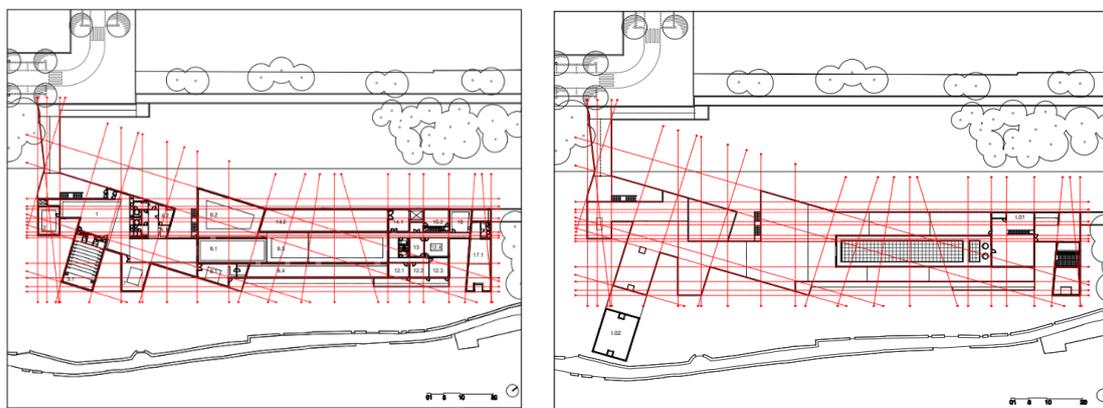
Plantas Fundação Nadir Afonso, piso1 e piso 2. (Siza Vieira, 2015).
